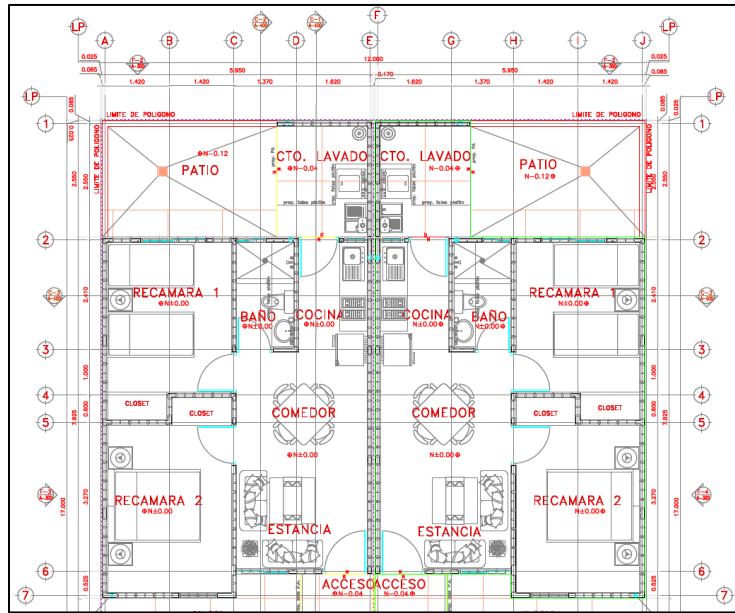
Planta arquitectónica de la vivienda convencional de interés social.
